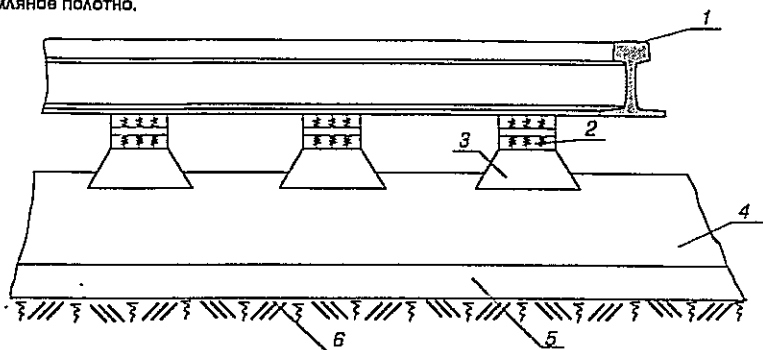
в - 1-1 - рельс; 2 - дискретное упругое опирание; 3 - подрельсовая конструкция - непрерывная балка; 4 - основная несущая конструкция; 5 - усиленное основания; 6 - земляное полотно.
